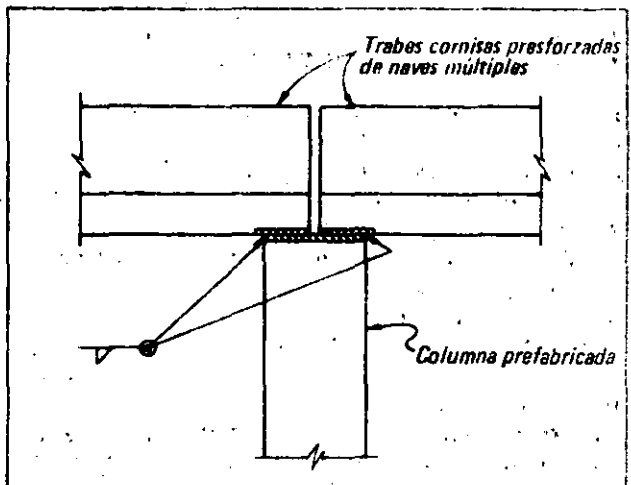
Soldadura de montaje para marcos de naves múltiples
